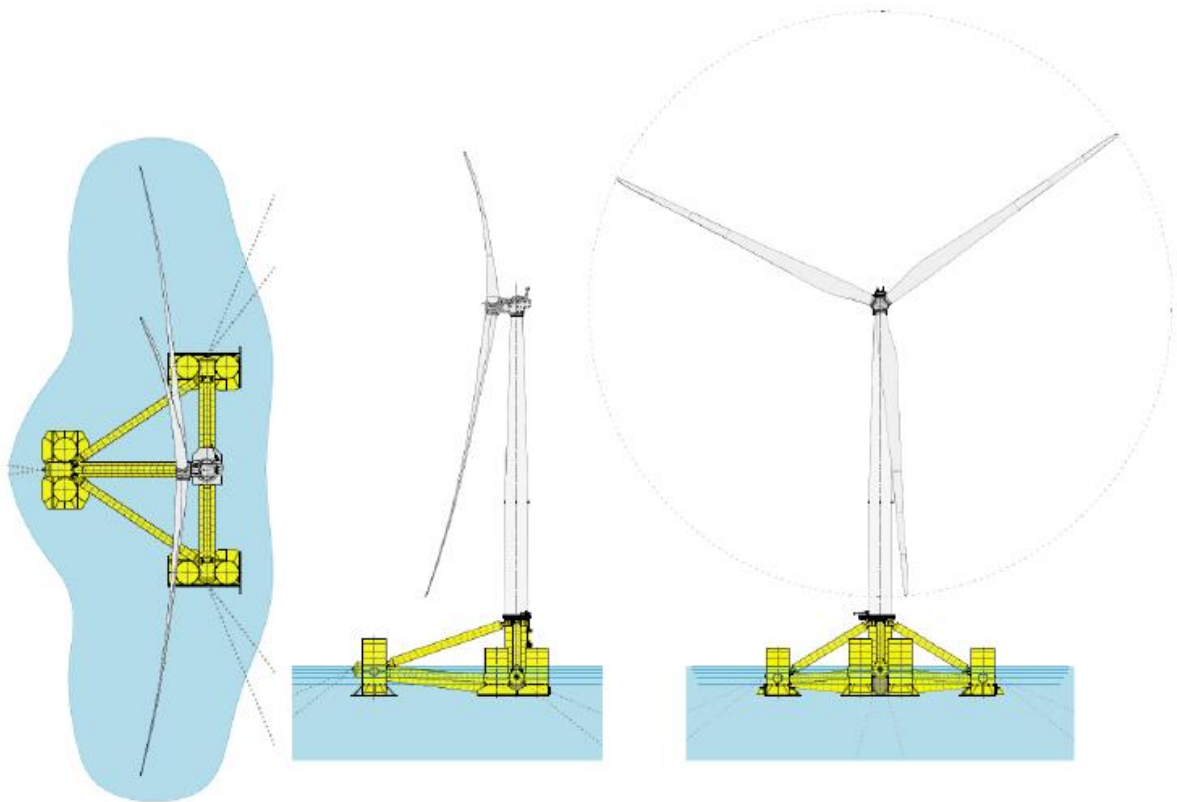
Stralcio elaborato C0420GR01RELGEN00g Relazione Generale – particolare della fondazione galleggiante SOT.
